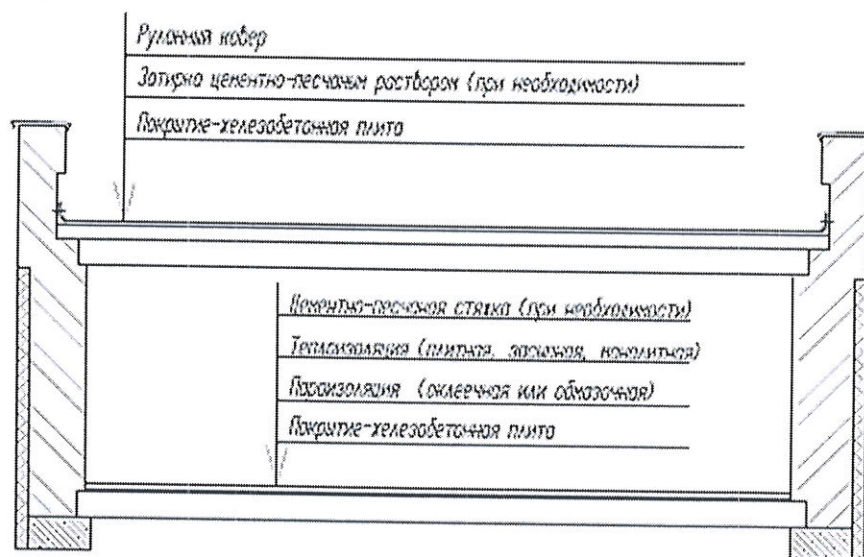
Конструкция плоской чердачной кровли (изоляция чердачного пространства плоской и скатной кровли выполняются одинаково)
